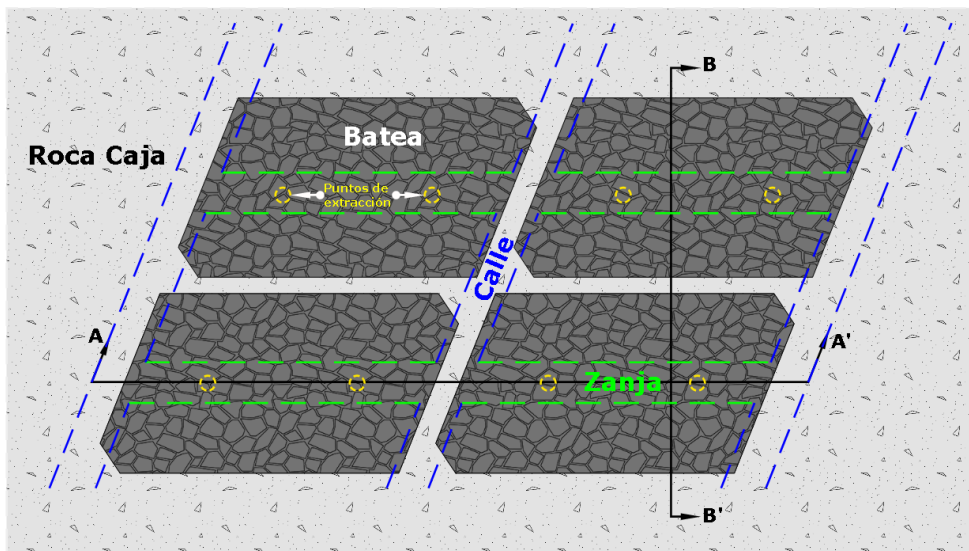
Vista en planta de bateas y ubicación de perfiles A-A', B-B', modificado de Arce, 2002
